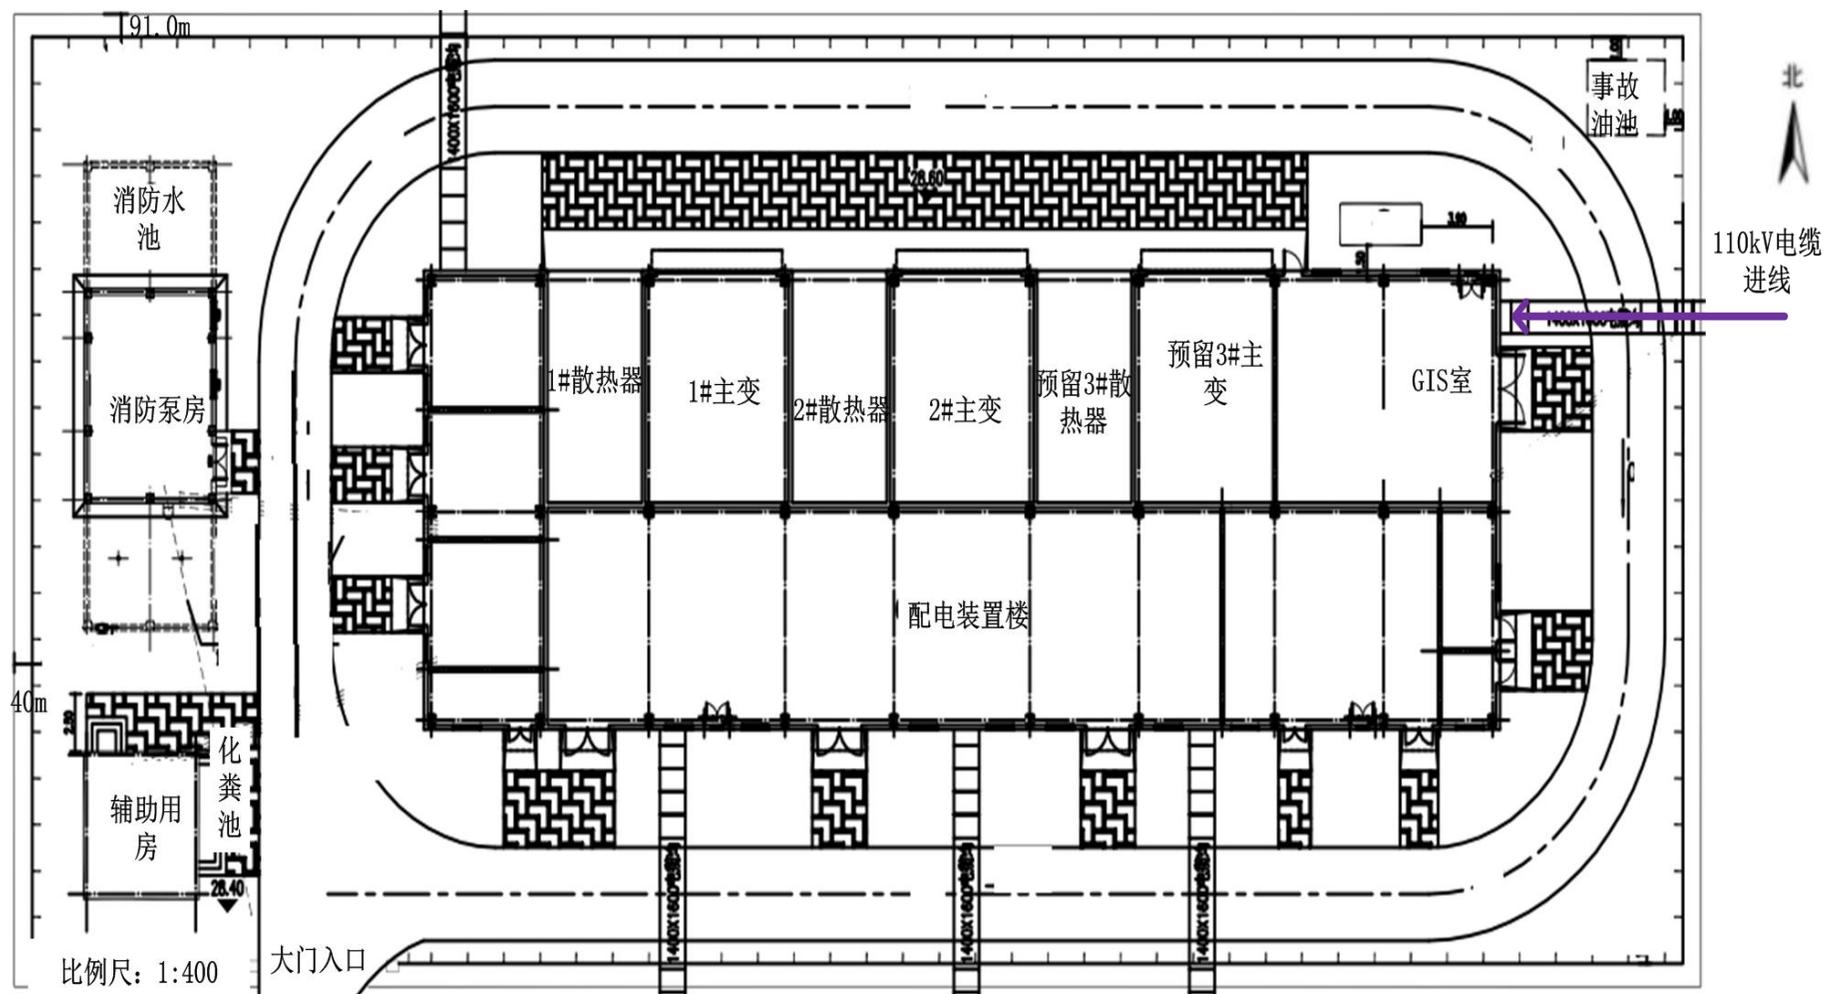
聊城高唐人和 110kV 变电站平面布置图
